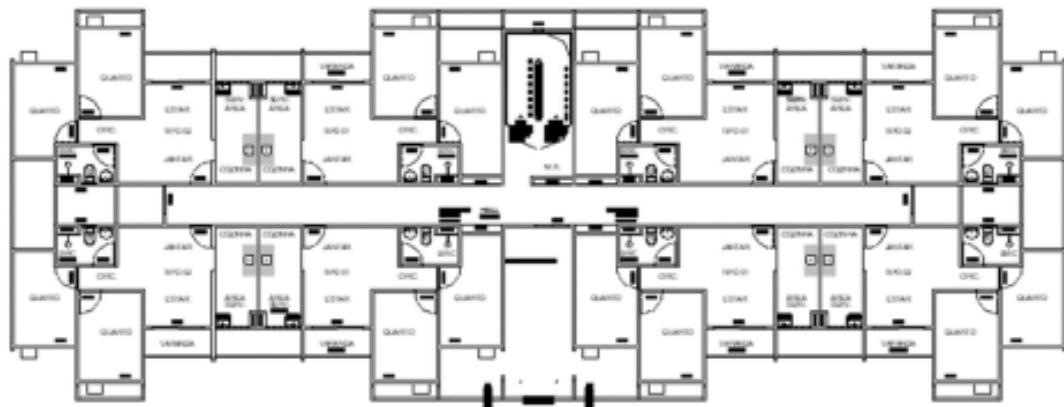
Parede de concreto 02, planta baixa do pavimento tipo
